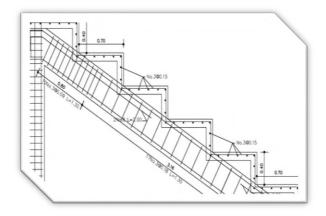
Acero de refuerzo vigas aéreas longitudinales gradería
